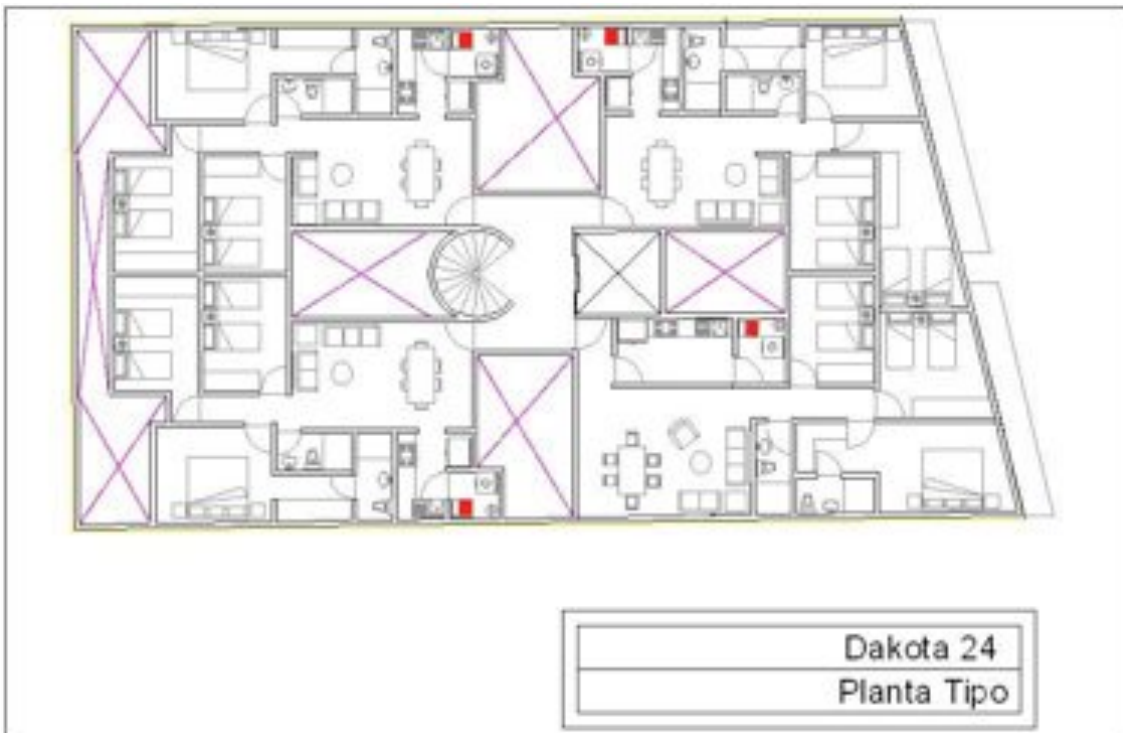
PLANTA ARQUITECTONICA TIPO
